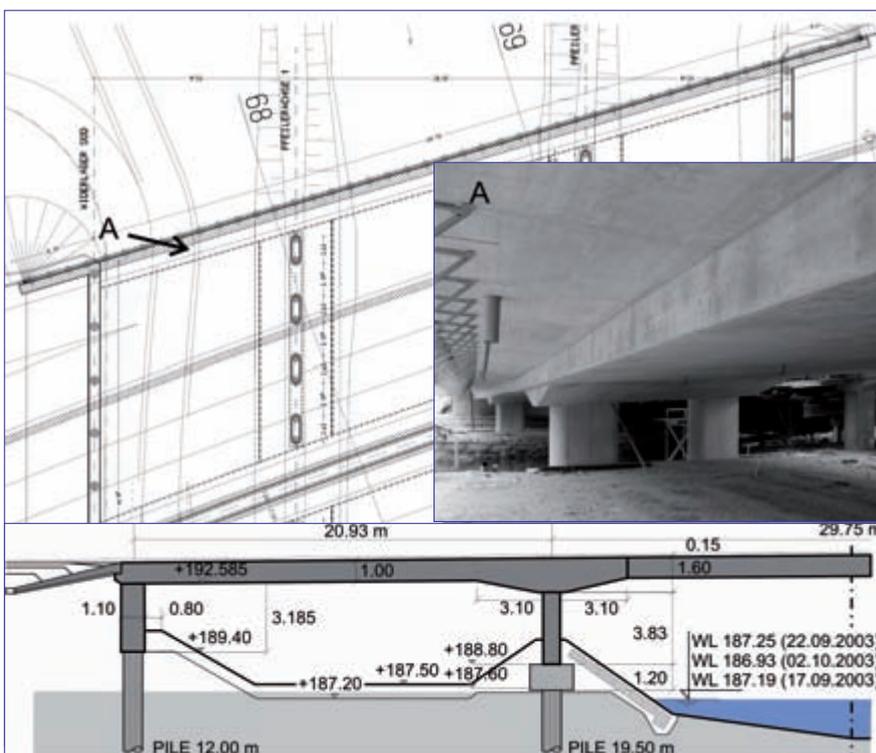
Marktwasser-Brücke S33.24, Grundriss, Unteransicht und Längsschnitt
